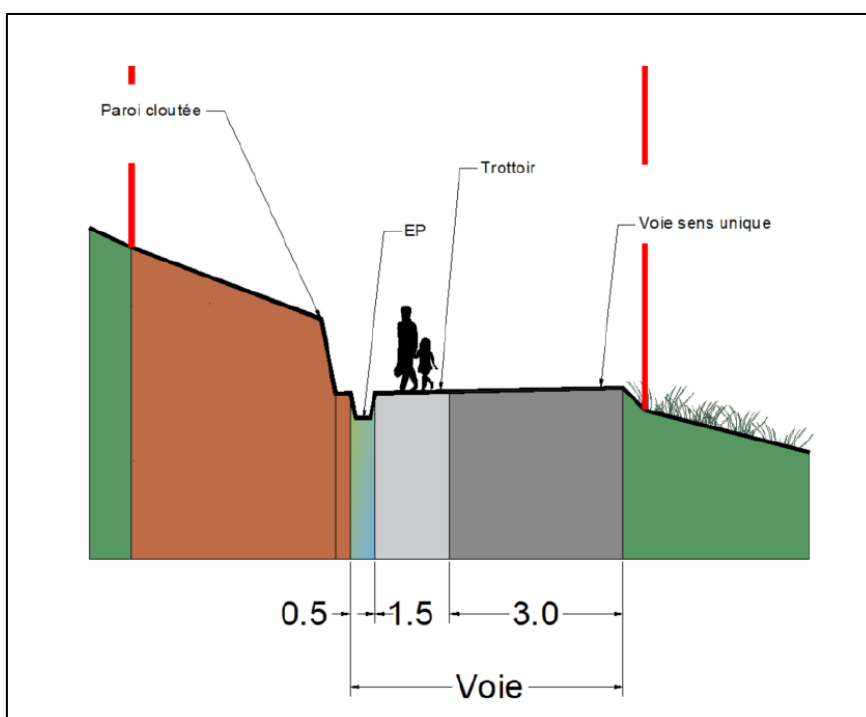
Profil en travers rue des Coteaux – Secteur 2
